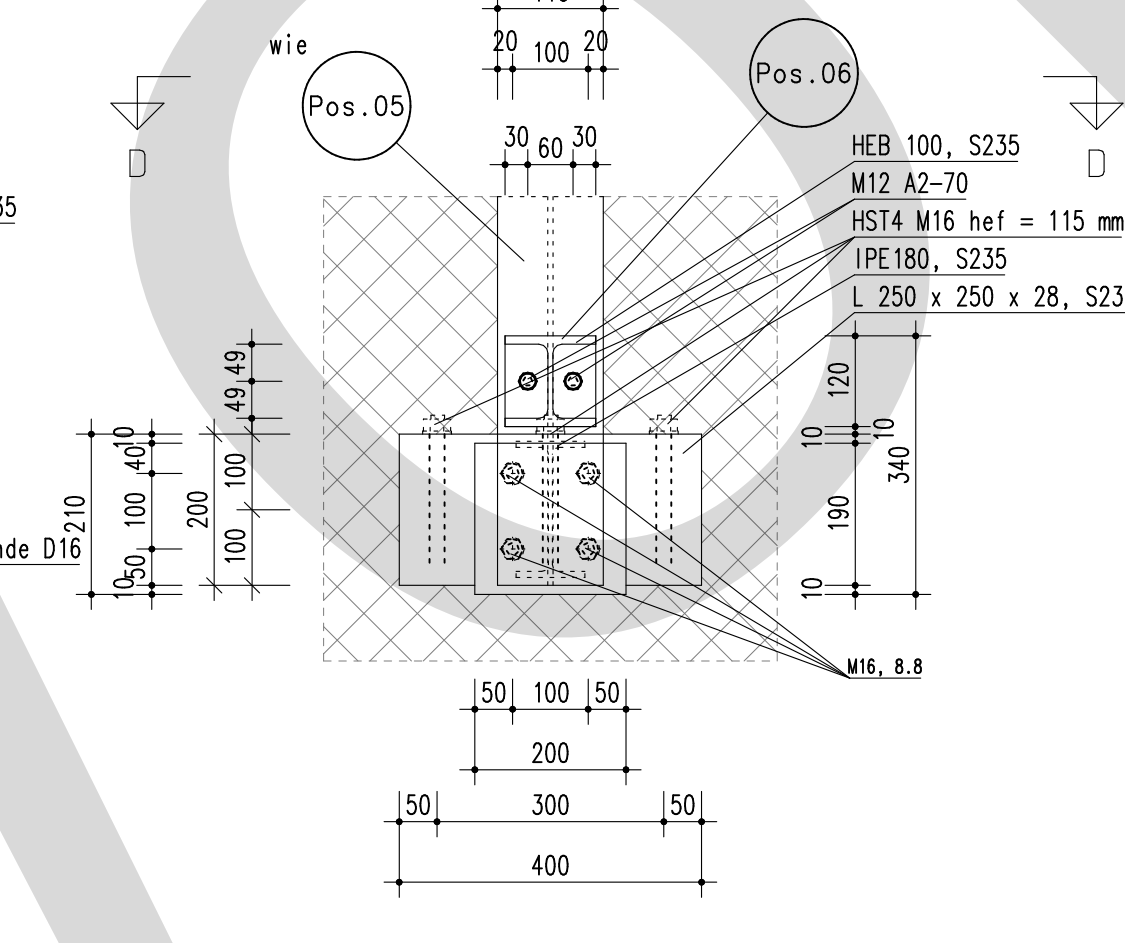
Anschluss der Fußkonsole an die Kellerdecke
